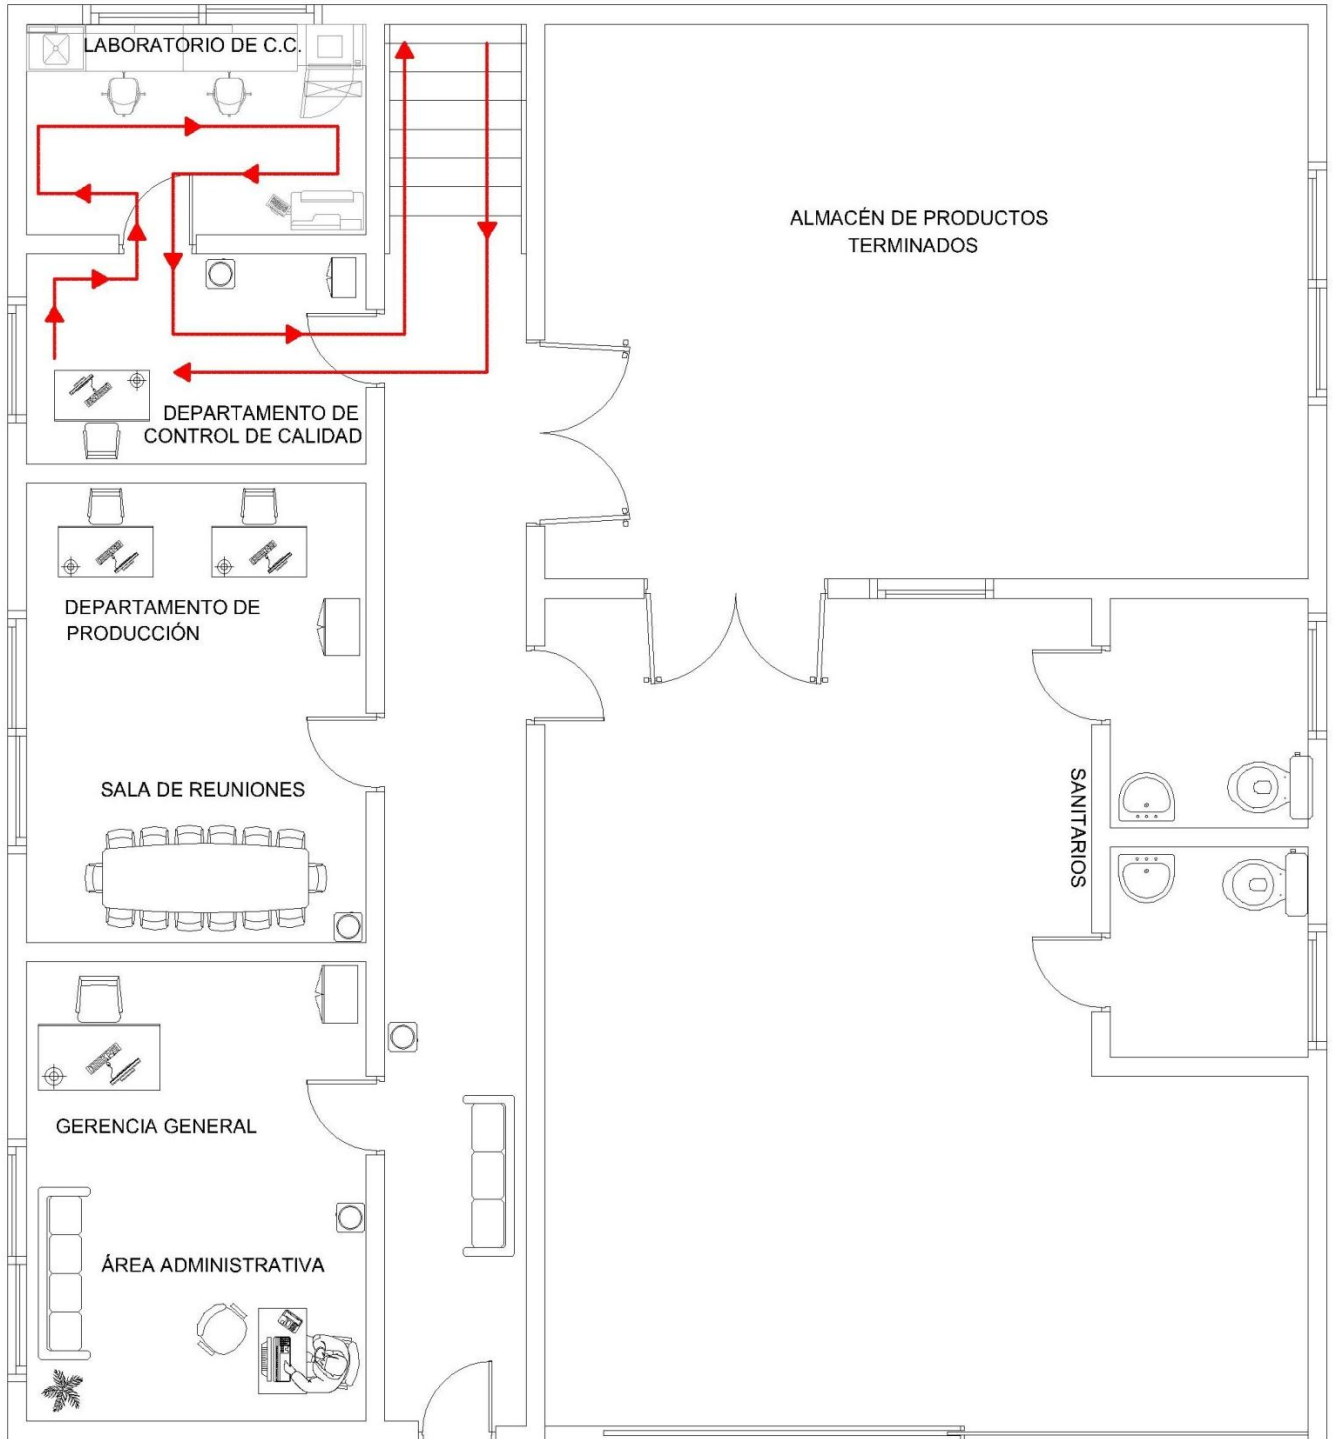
Plano: Recorrido en planta baja del Auditor de calidad. Fuente: Rondón (2018)
